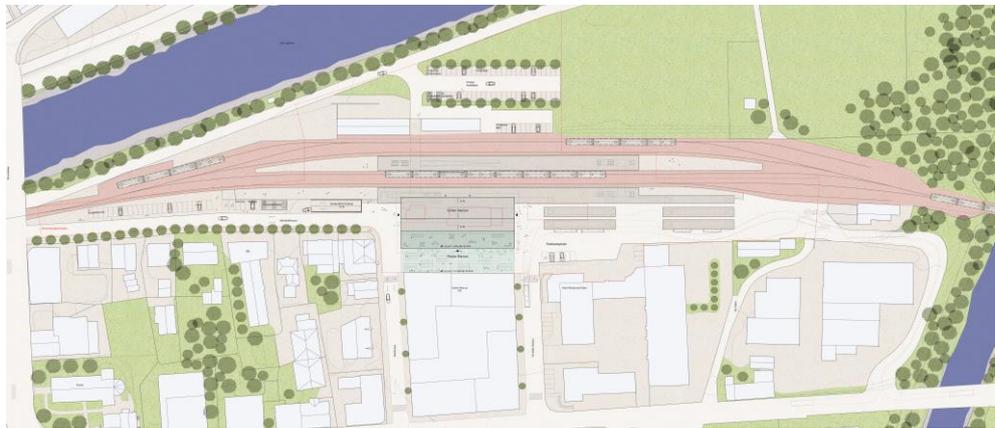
Situationsplan «Retica» (nicht massstäblich)
